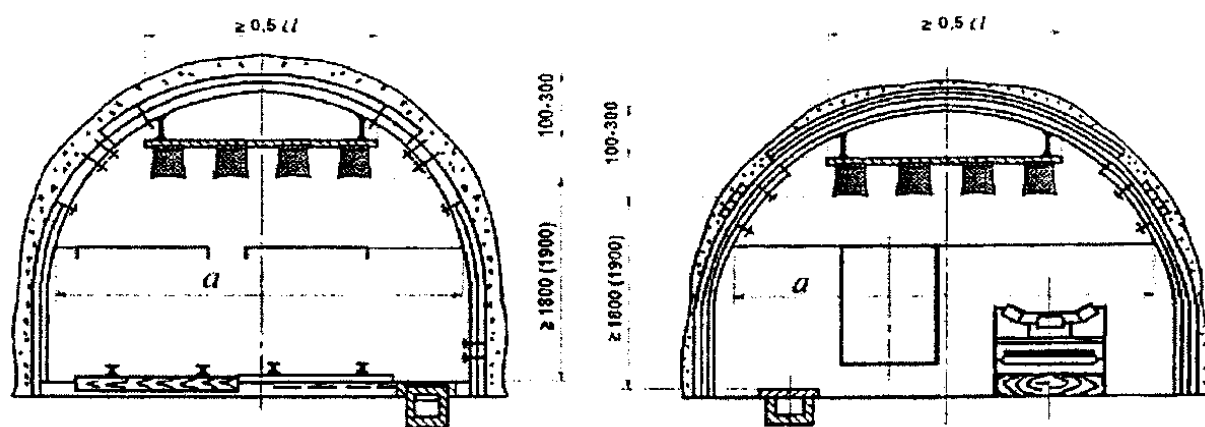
Схема установки водяного заслона из водяных карманов под кровлей выработки
